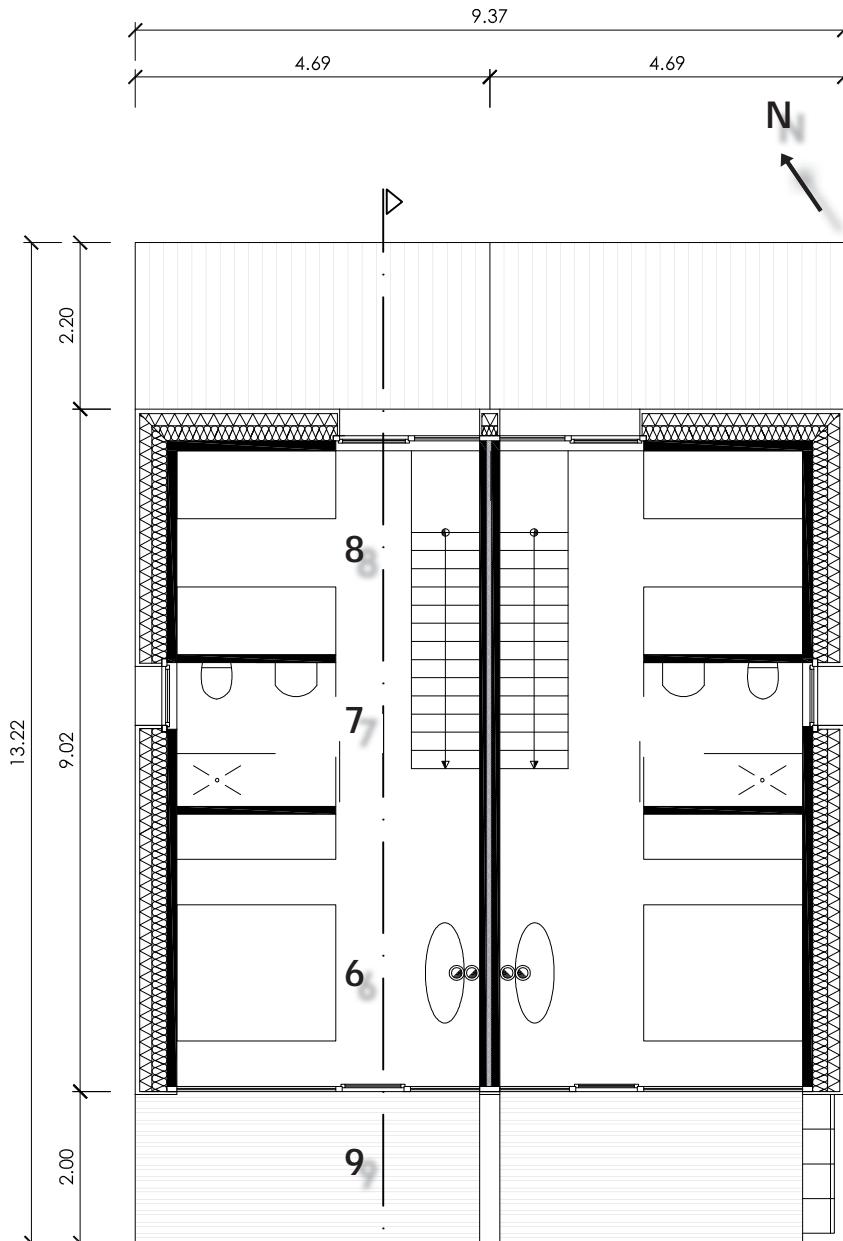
Grundriss OG - Haustyp 1 - M 1:100
